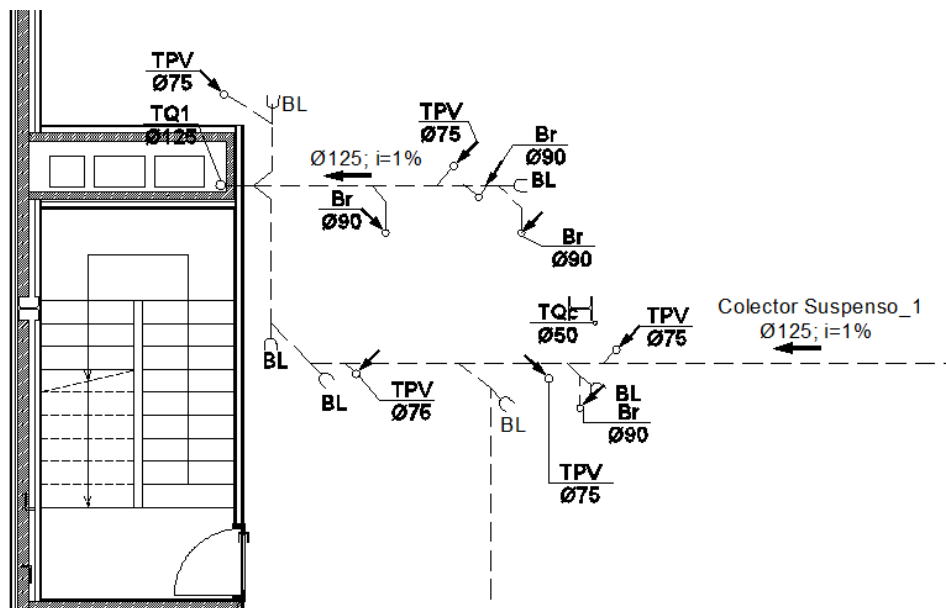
Excerpto da planta do tecto do piso 2, com ligações ao colector suspenso
